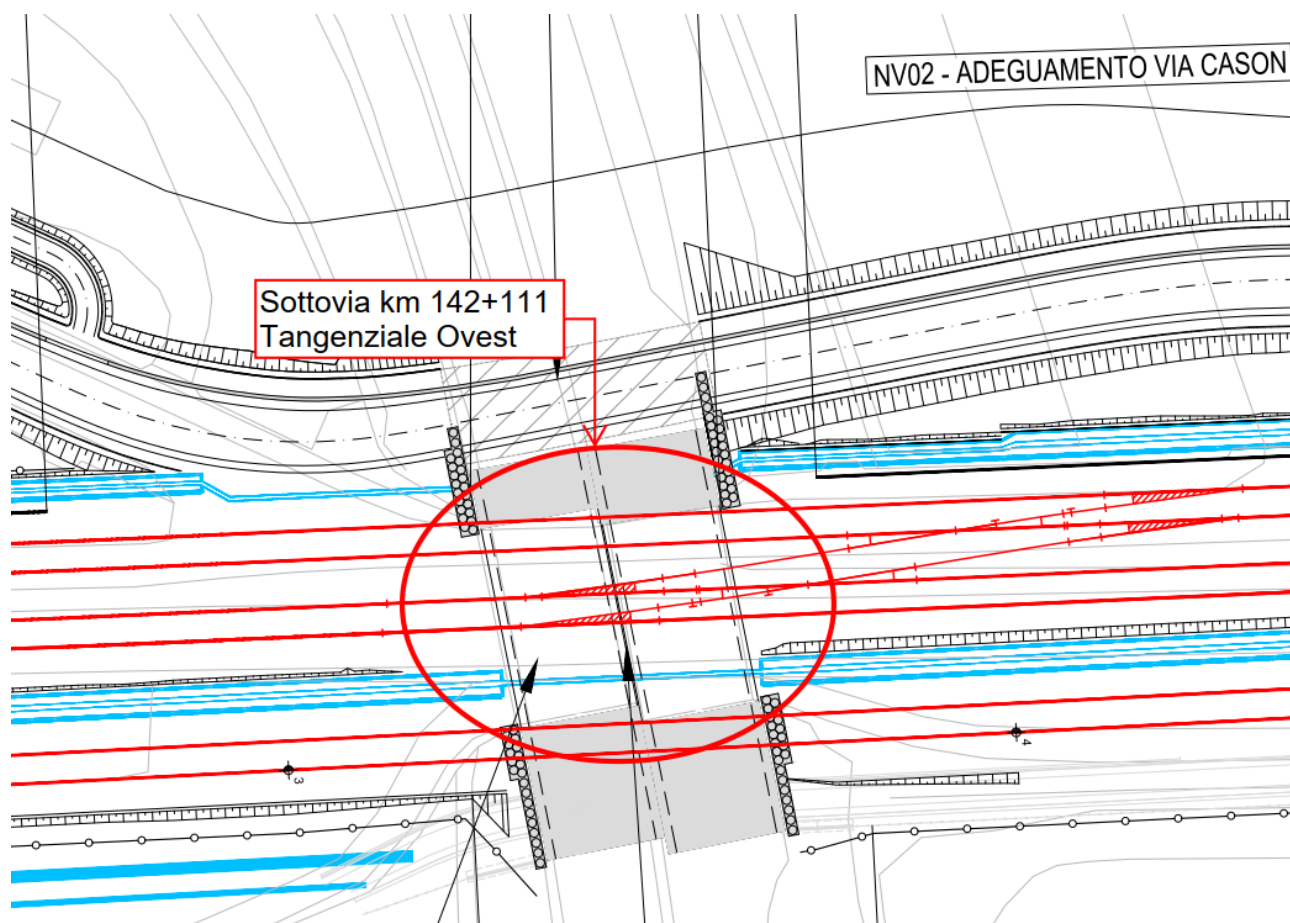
Planimetria dell'intervento del sottovia ferroviario, situato in corrispondenza del km 142+111
